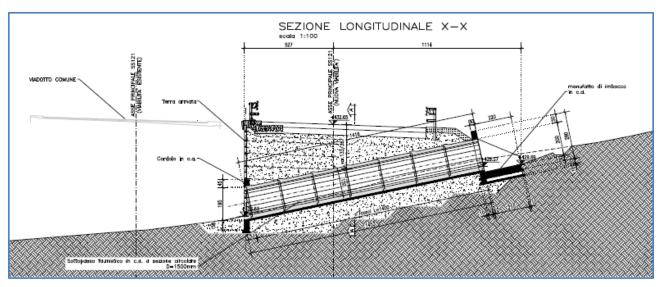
Profilo longitudinale sottopasso faunistico TF06.
